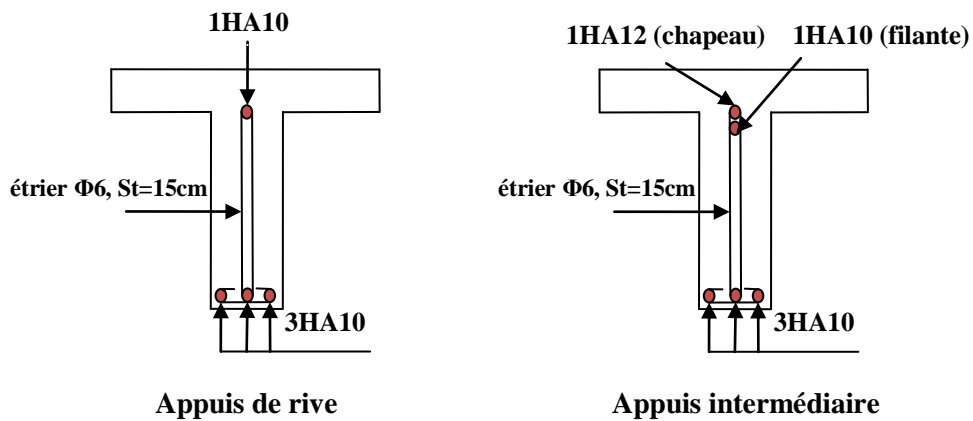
Schéma de ferrailage de la dalle de compression et des poutrelles.
